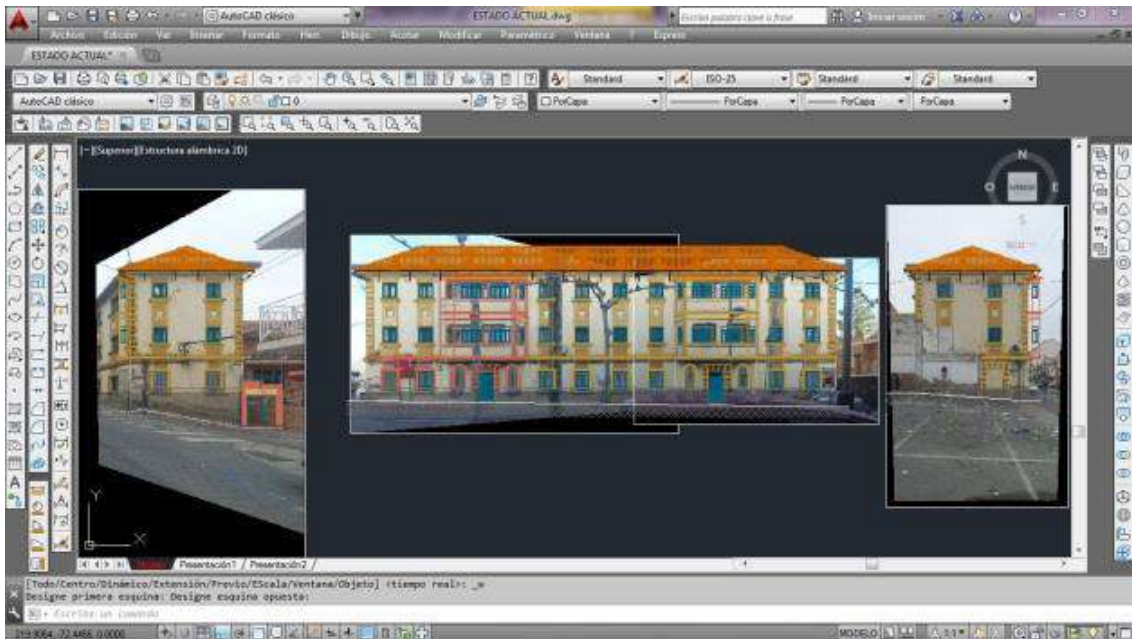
Proceso de Levantamiento de detalles de las Fachadas en Autocad. 2016. Fuente propia.
